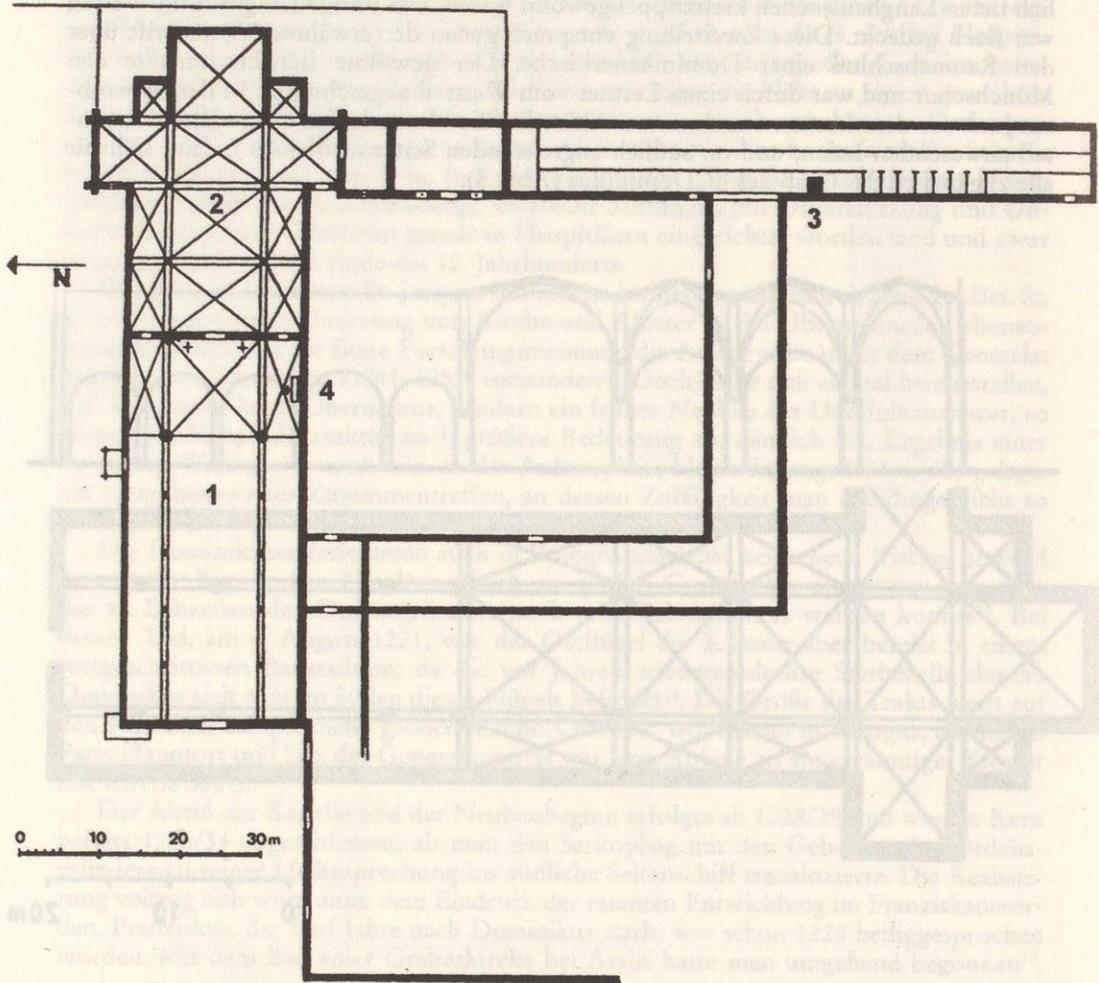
Bologna, San Domenico, Grundriß mit Lettner (nach d'Amato 1988)
